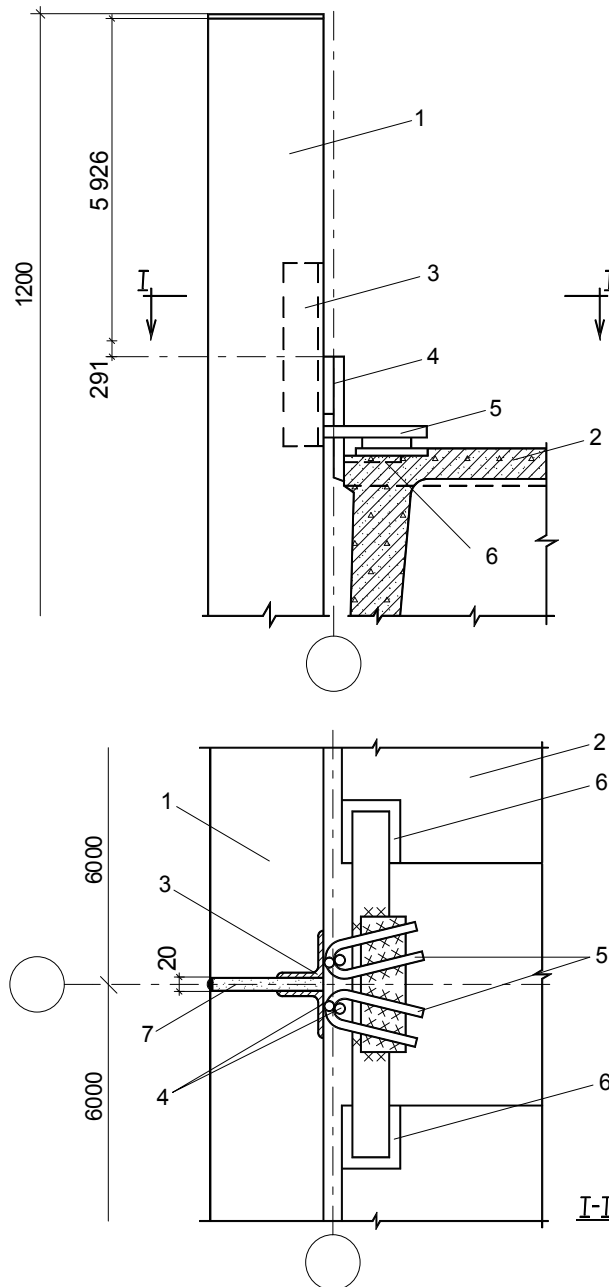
Кріплення парапетних панелей поздовжньої стіни до плит покриття безкранової будівлі біля рядової осі: 1 – парапетна панель; 2 – плита покриття; 3 – закладний елемент парапетної панелі; 4 – круглі стержні $\varnothing 25$; 5 – петля з круглого стержня; 6 – закладний елемент плити покриття; 7 – цементний розчин
